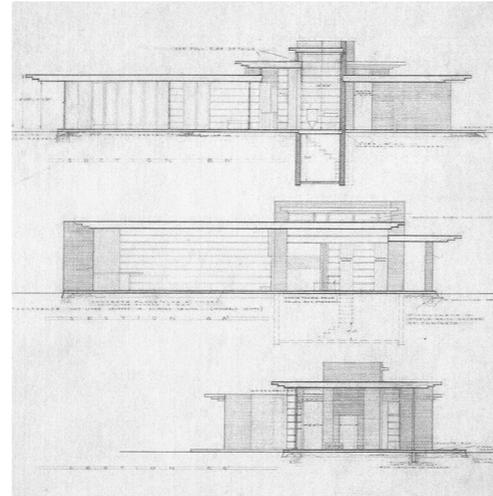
(do topo) Corte Longitudinal através da entrada; Corte Transversal; Corte Longitudinal
